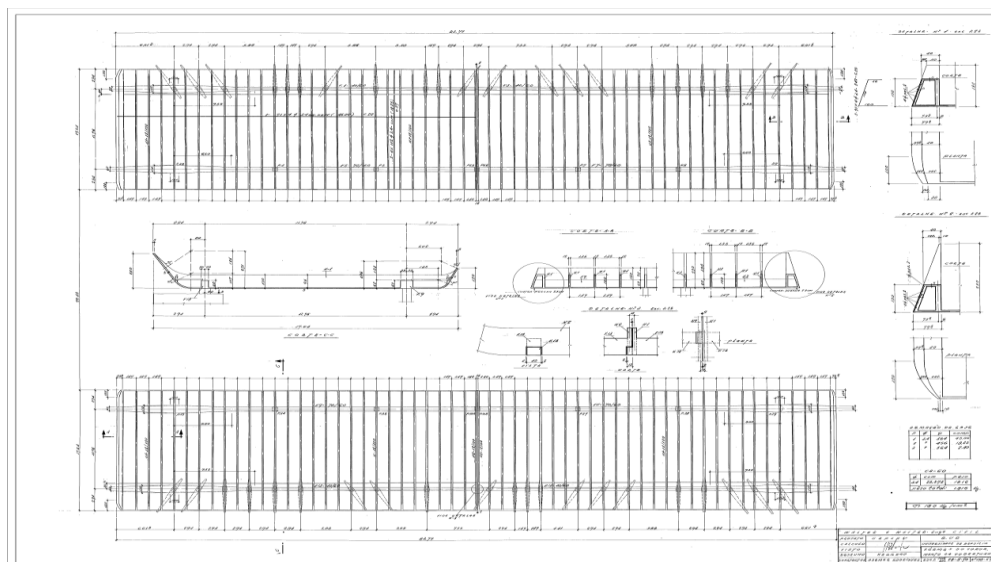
Detalhamento das lajes de coroamento (CEPLAN).
